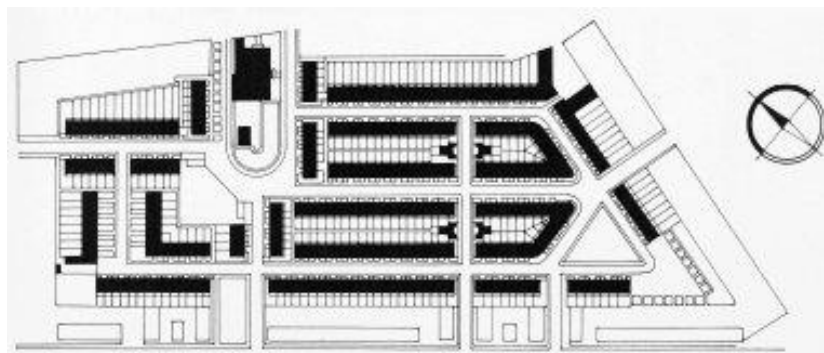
Planta do bairro Kiefhoek, Roterdão, Jacobus Johannes Pieter Oud,
